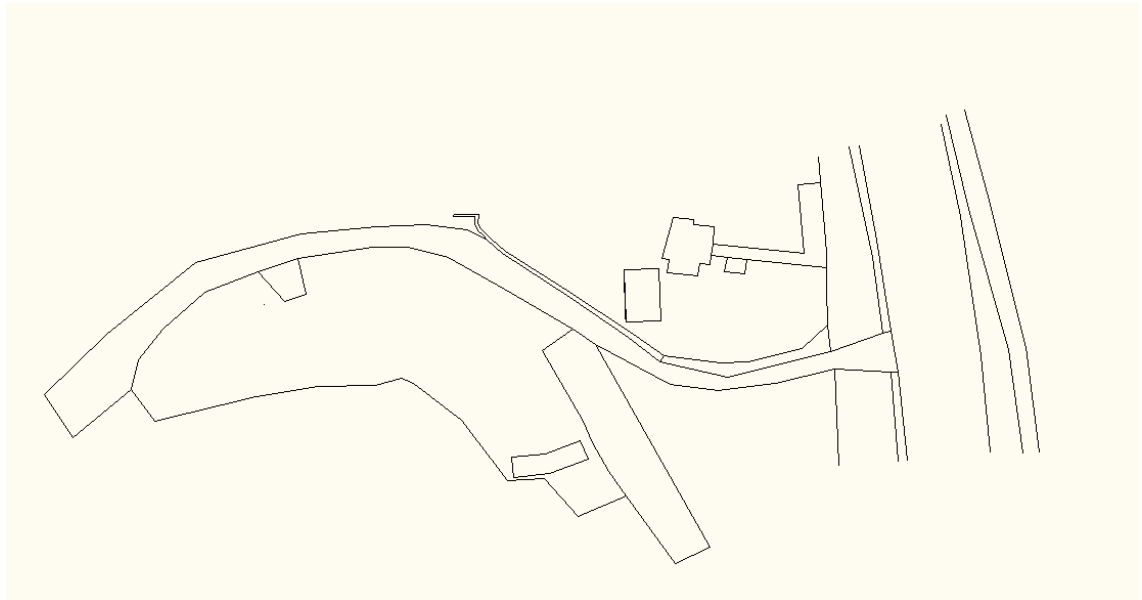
Plano de zona de inundación en Autocad, zonas y edificios.
